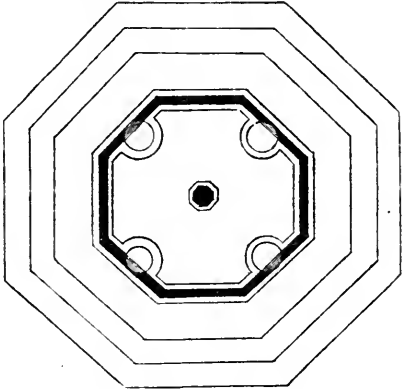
Grundriss des Baptisteriums zu Pisa.
